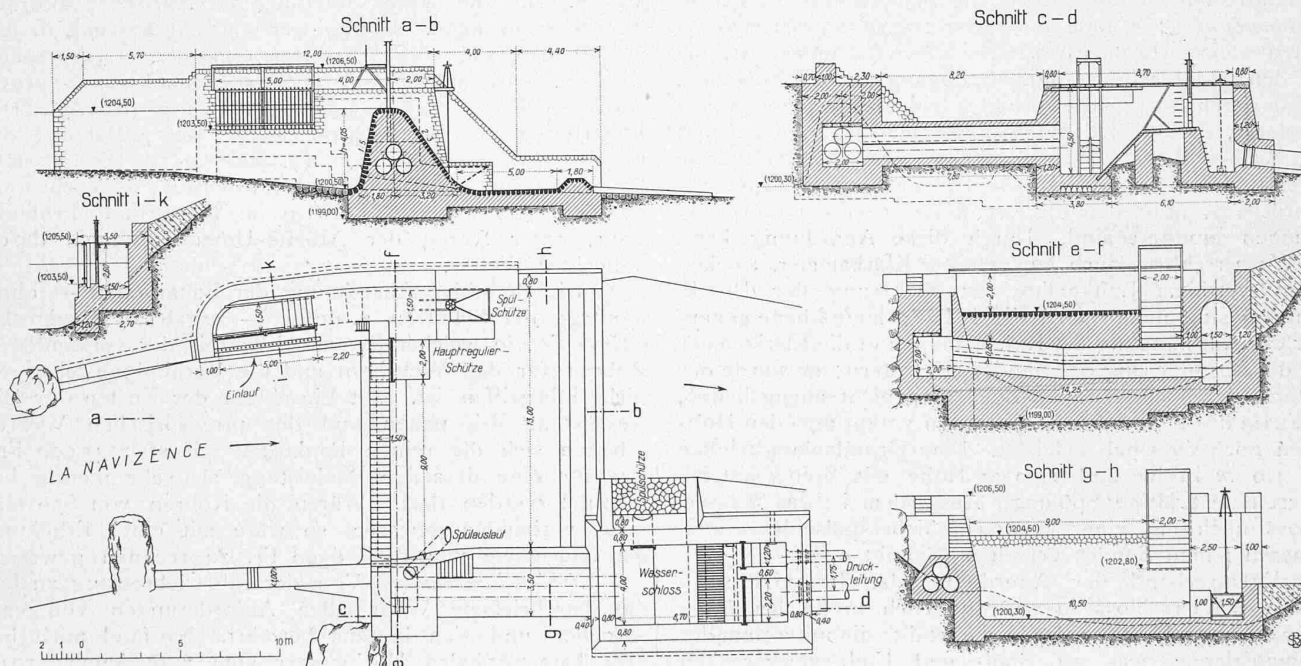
Grundriss und Schnitte des Stauwehrs samt Einlauf und Wasserschloss. — Masstab 1:350.
